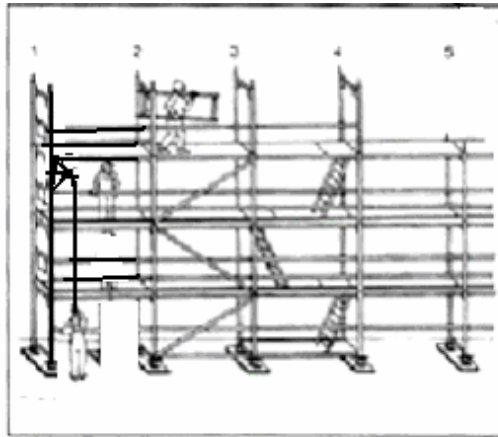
Montaggio e smontaggio con sollevamento degli elementi mediante un argano a livello inferiore del piano di assemblaggio
